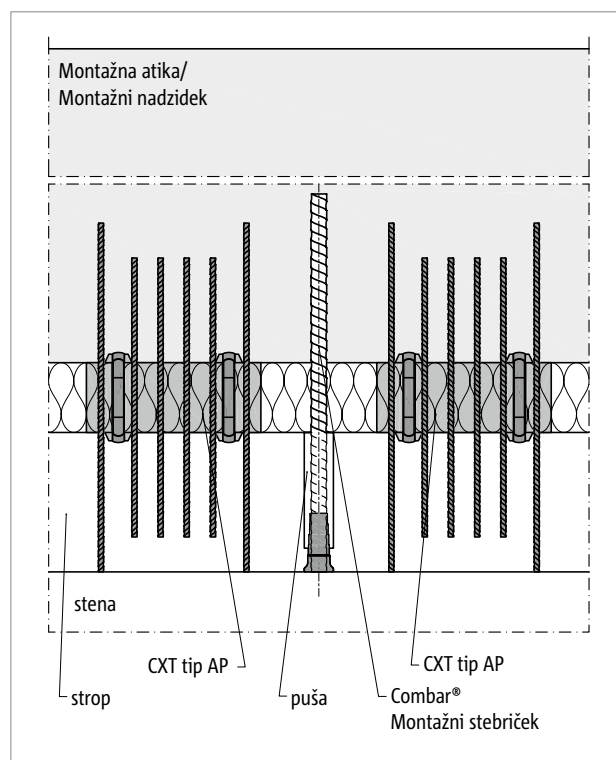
Montažni stebriček Schöck Combar®: projektne dimenzije
